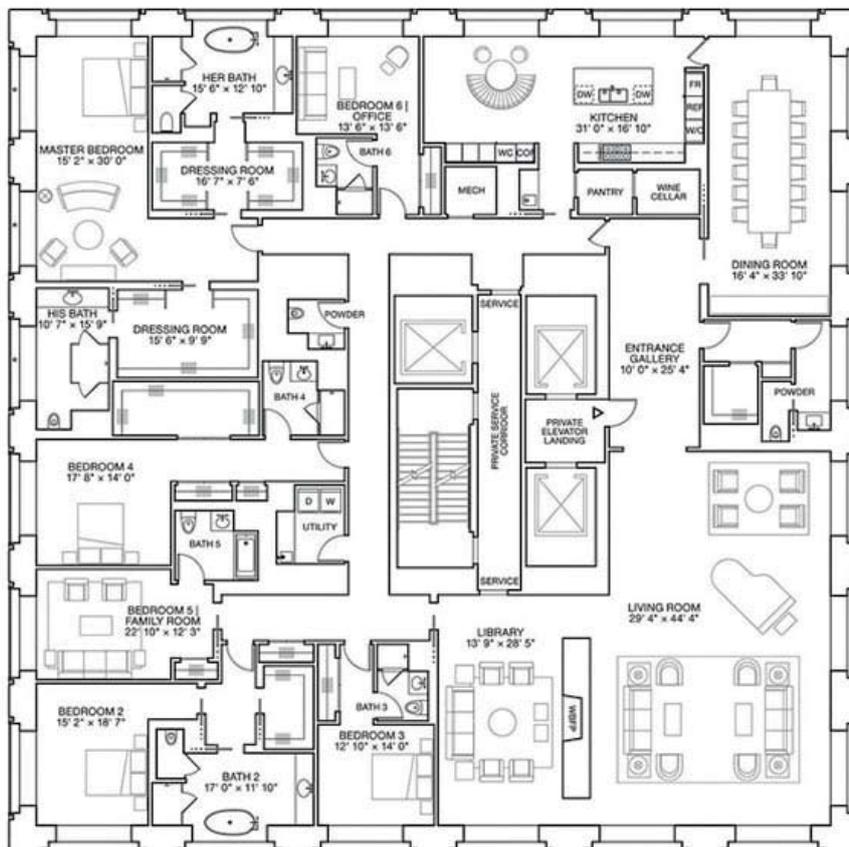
Grundriss des 423 Park Avenue (Quelle: <http://highrisefacilities.com>)
